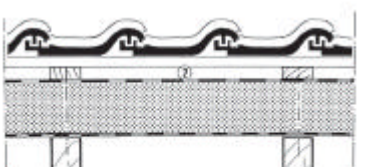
Aufsparrendämmung: Dämmelement auf Sparren mit einer Lüftungsebene, Sparren raumseitig verkleidet
